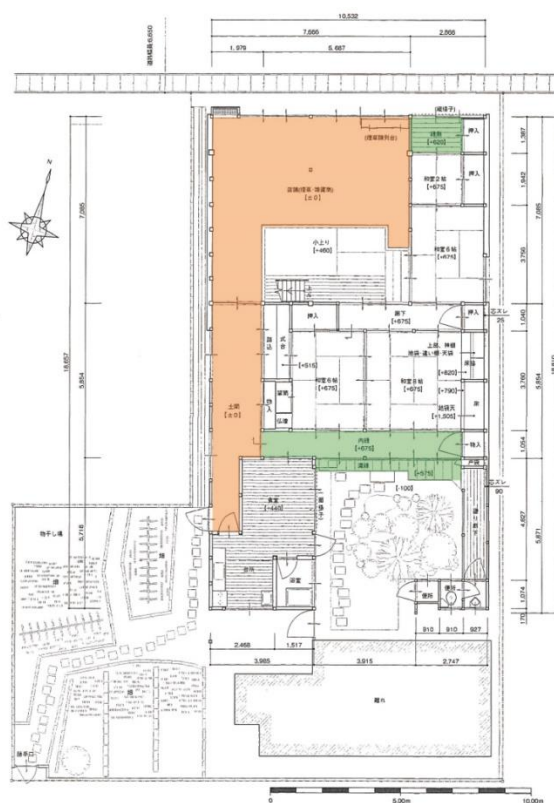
聖建築研究所からいただいた西内たばこ店の平面図
